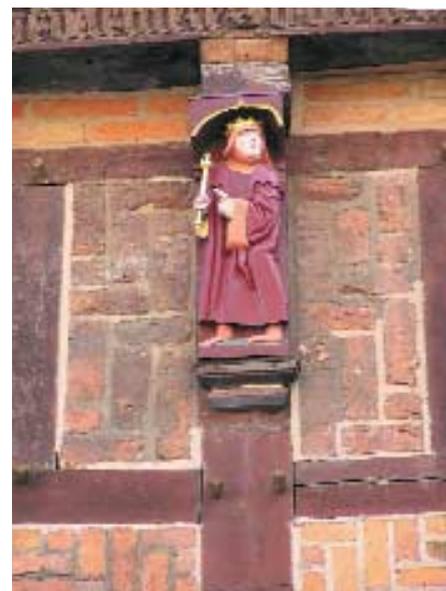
Ausfachung mit Ziegelsteinen als Sichtmauerwerk, Fachwerkhaus Perleberg, erbaut im 16. Jahrhundert
